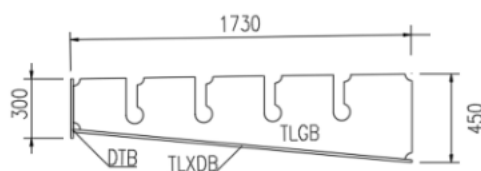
钢箱梁模块纵、横向连接示意图（单位：mm）
